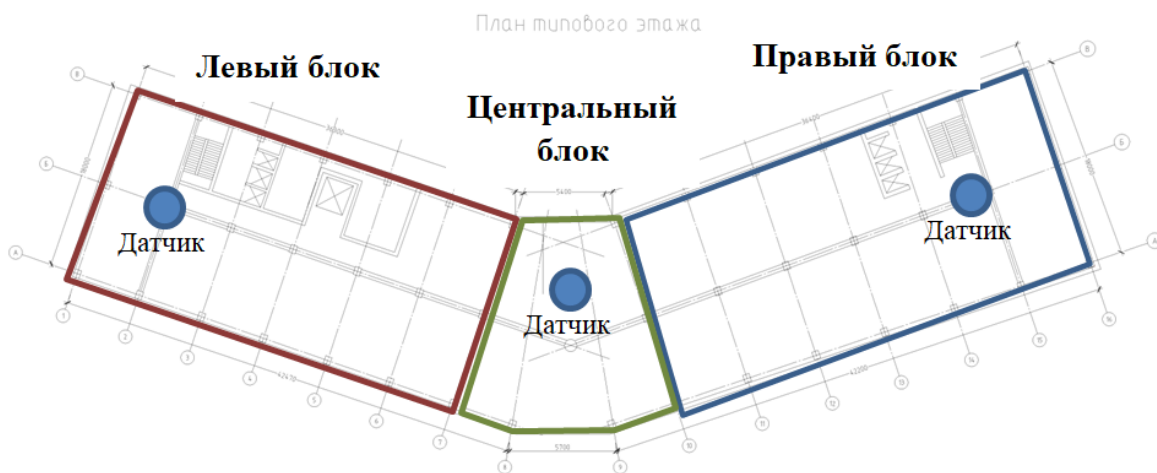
Схема размещения датчиков на кровли здания
